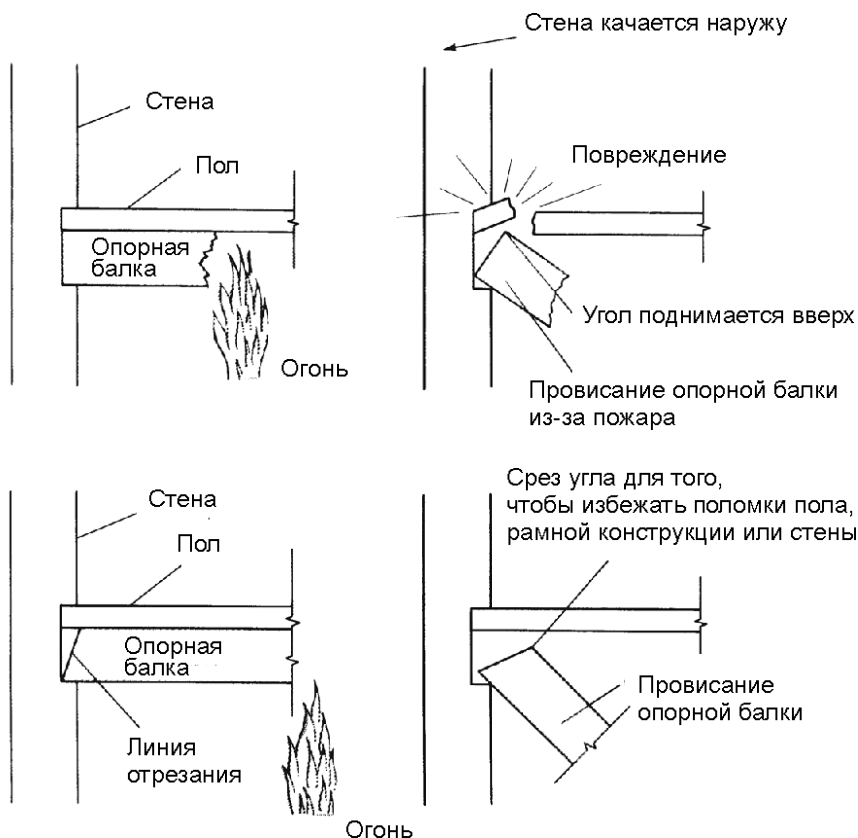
Для сплошных стен торцы опорных балок должны быть отрезаны под углом
